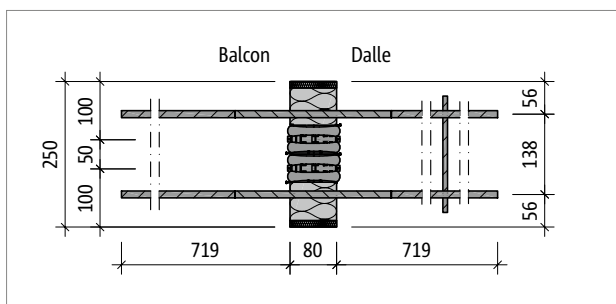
Schöck Isokorb® T type Q-E-V6-L250 : plan de base du produit
